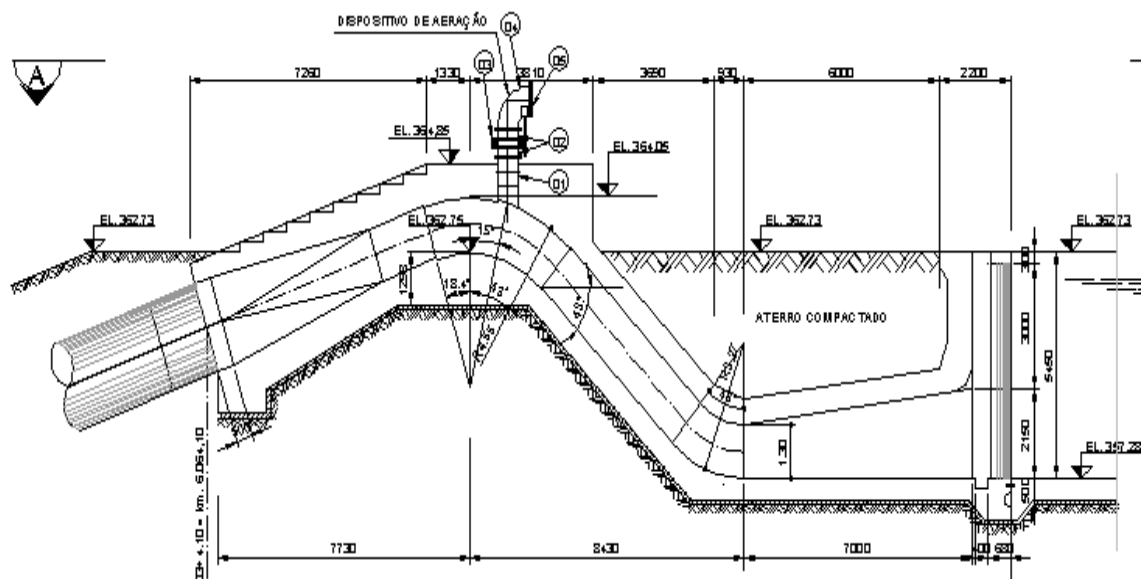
Instalação típica da estrutura de deságue - corte
